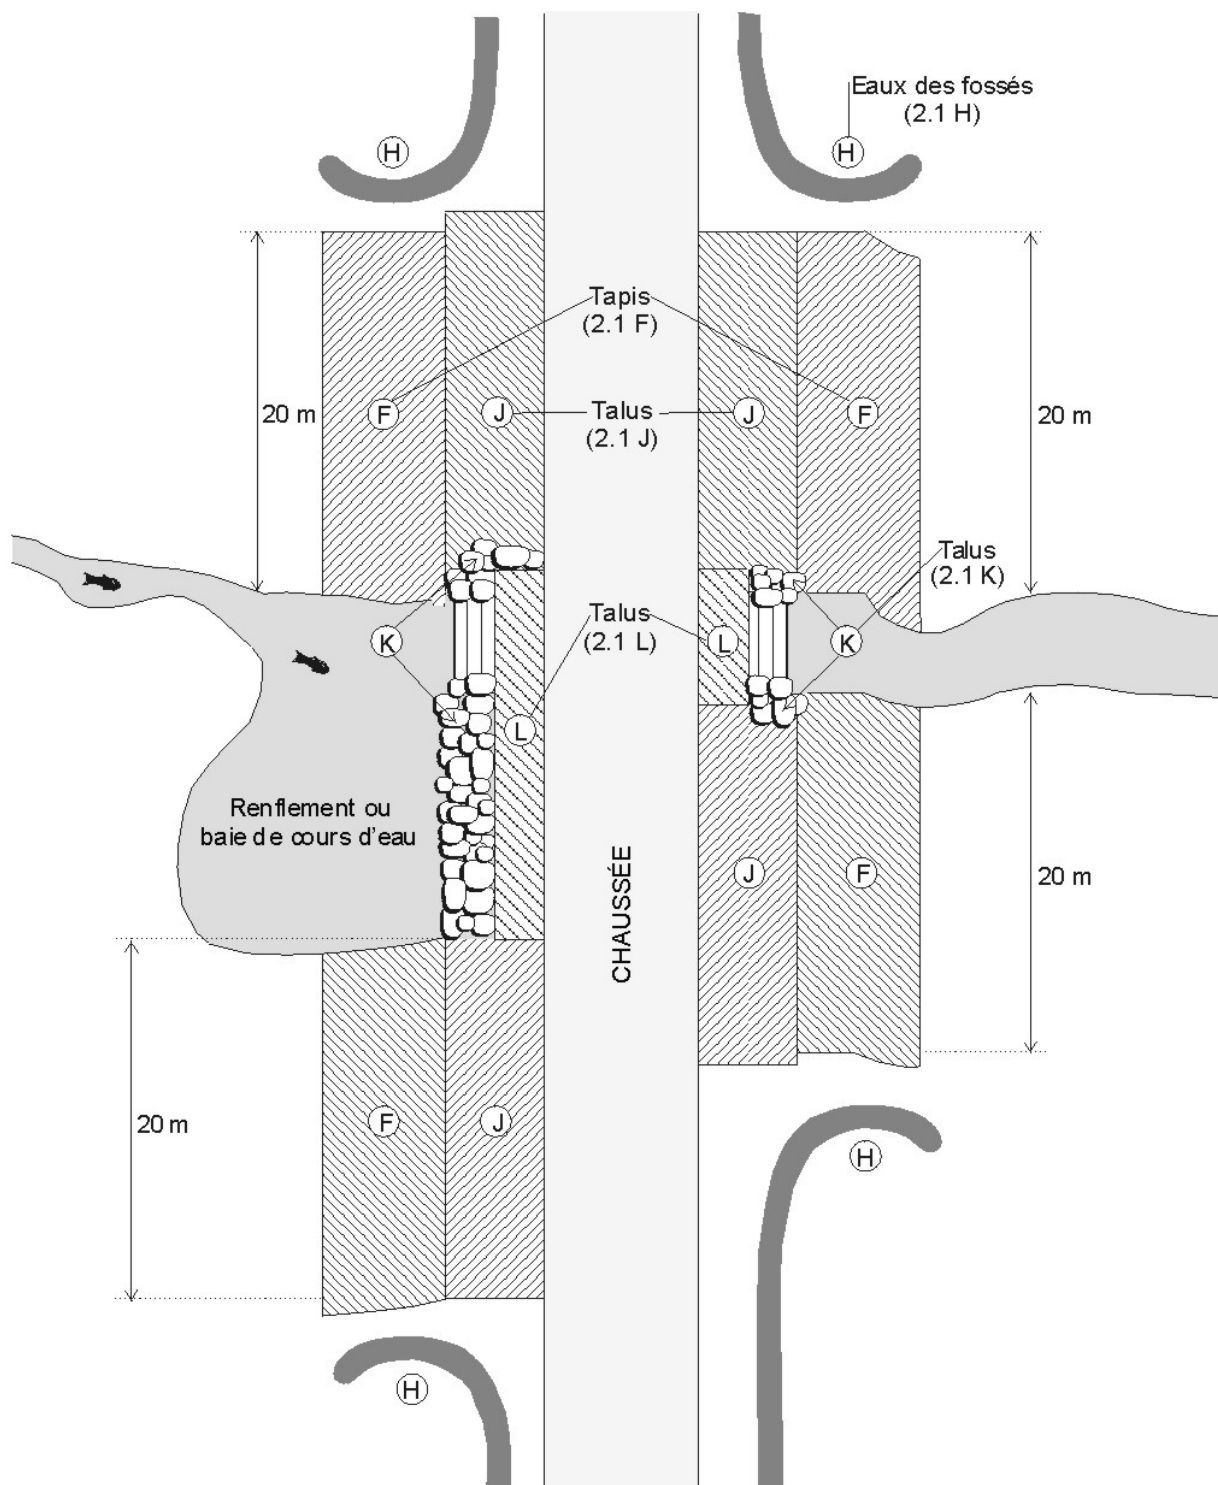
(b) Application des dispositions du RNI lorsqu'un chemin longe la berge d'une baie de cours d'eau ou d'un étang de castor
